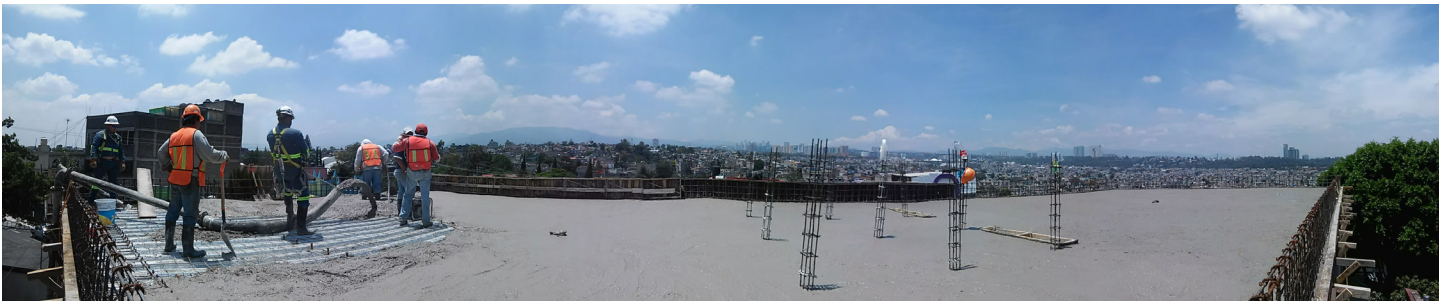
Armado de los muros de carga para el cubo del elevador.
